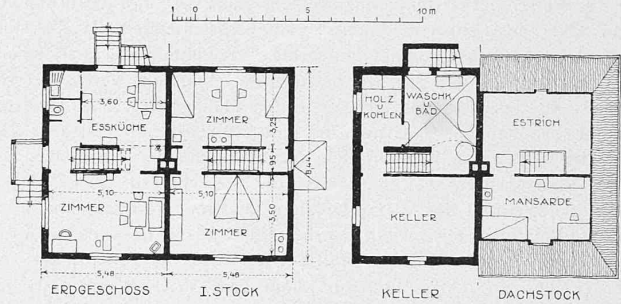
Grundrisse der ausgeführten Häuser. — Masstab 1 : 300. — Abb. 4. Grundrisse laut erstem Vorschlag.
